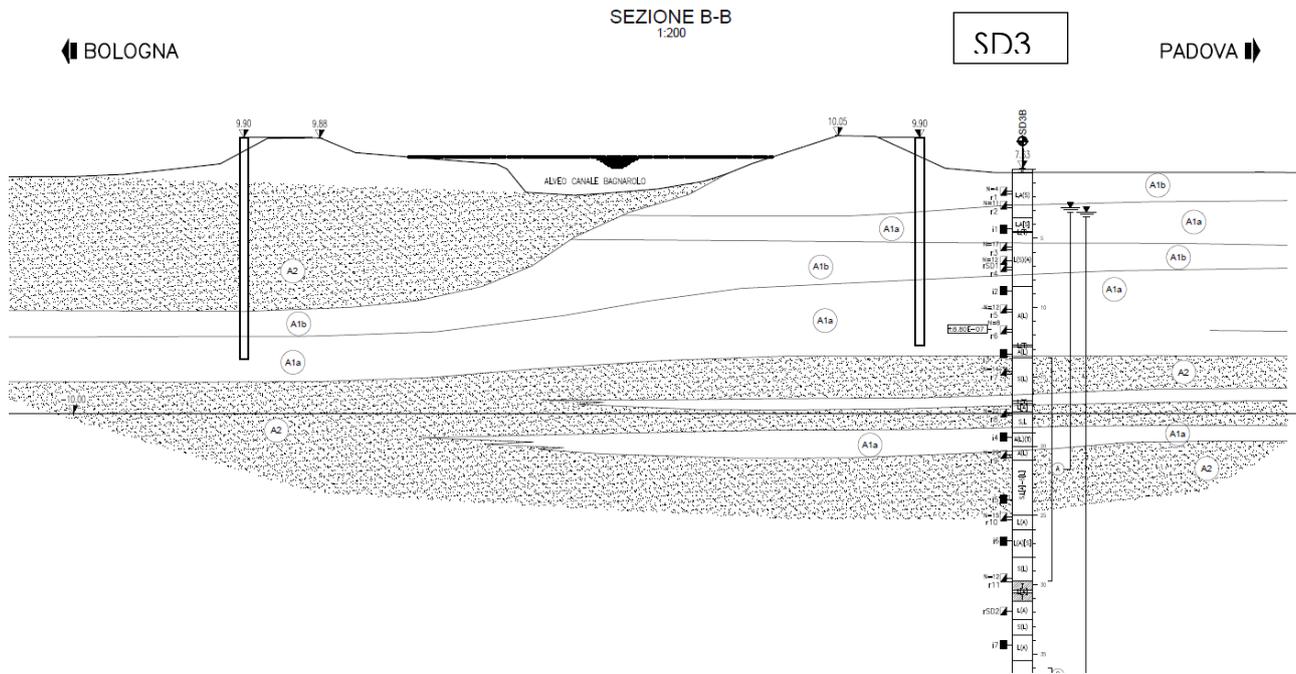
Ponte Canale Bagnarolo - Sezione geotecnica B-B
